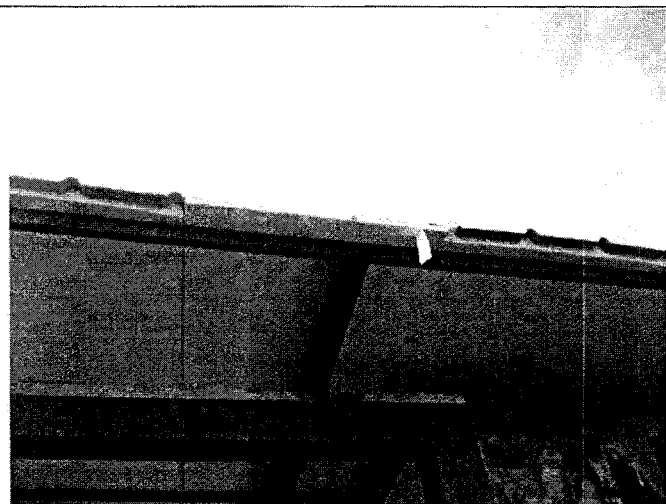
Telha Termo acústica instalada não corresponde ao especificado na planilha pactuada.
